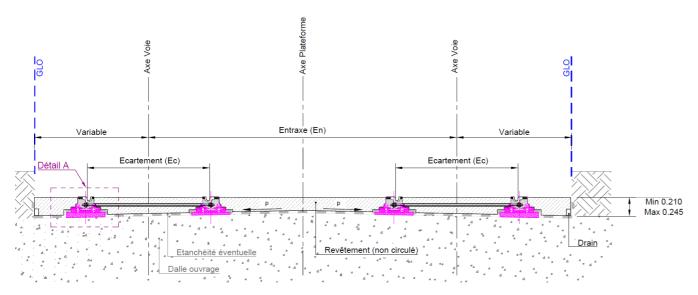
coupe type d'une plateforme pour voie sur selles collées par résine sur ouvrage
